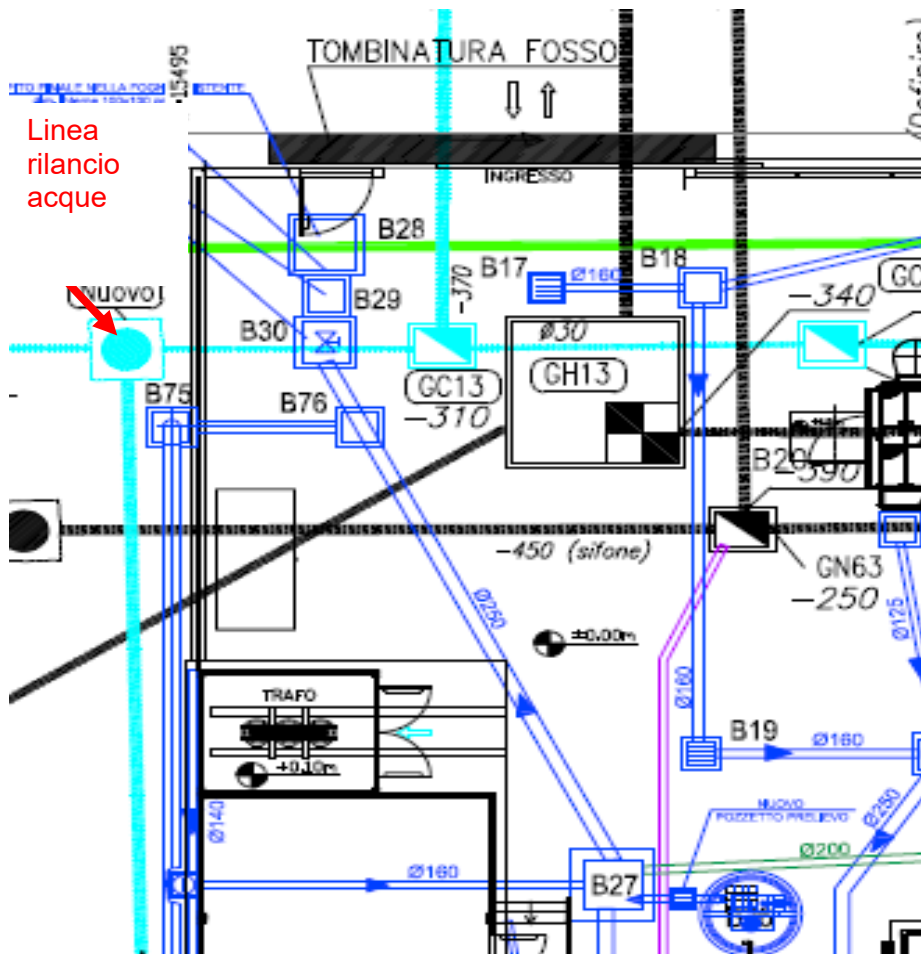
Stralcio della Planimetria Reti Interrate del nuovo impianto di cogenerazione con particolare del punto di connessione alla rete Alcantara S.p.A., esistente (pozzetto B28).
